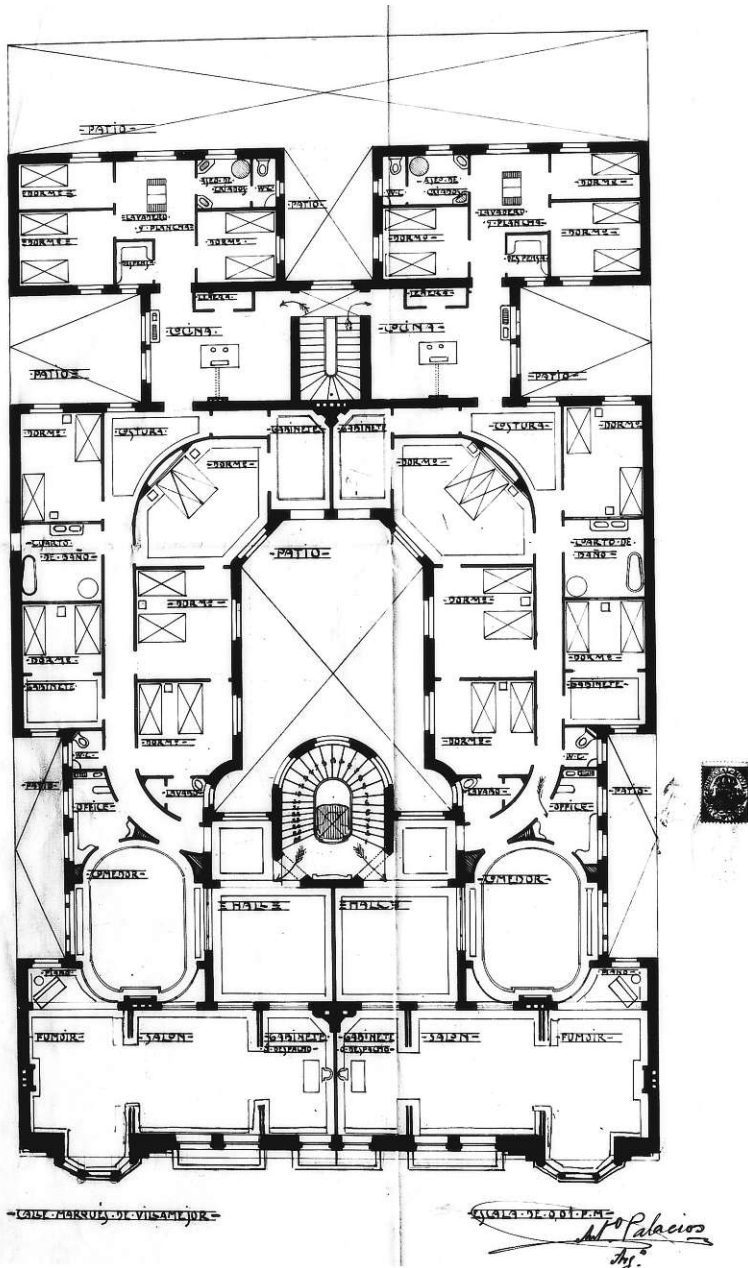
Grundriss Hauptgeschoss, 1. und 2. Obergeschoss, Calle del Marqués de Villamejor 3 - Antonio Palacios, 1906
